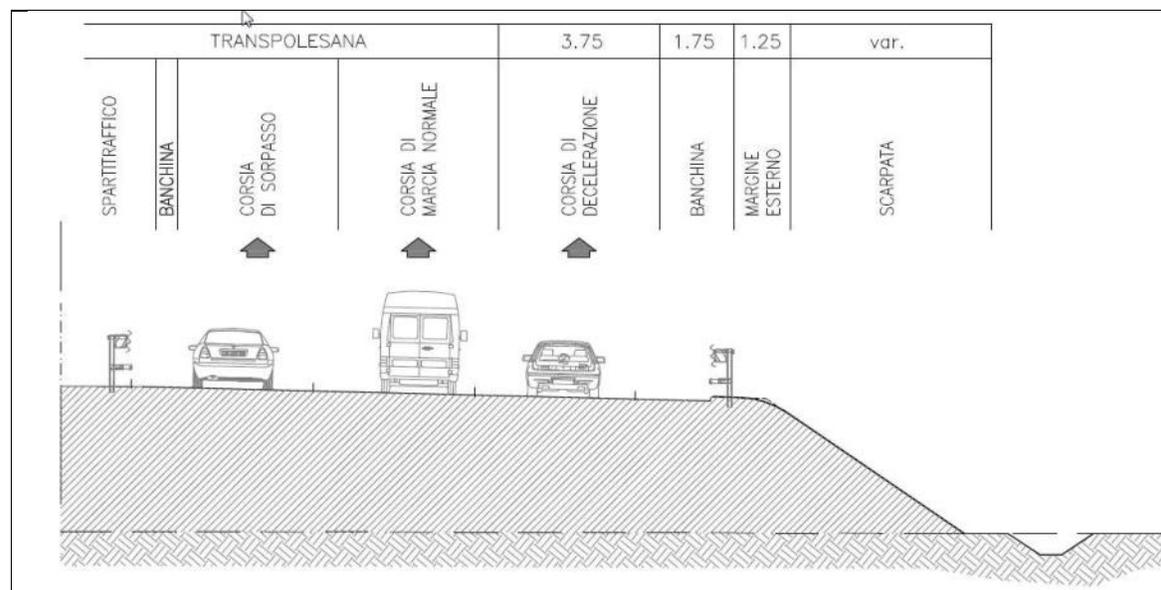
progetto preliminare: sezione trasversale tipo con corsia specializzata
